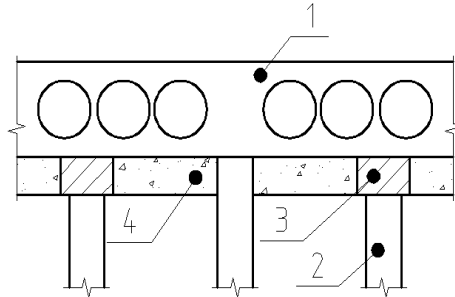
Конструктивная схема фундамента с поэтапно циклической схемой передачи нагрузки:
